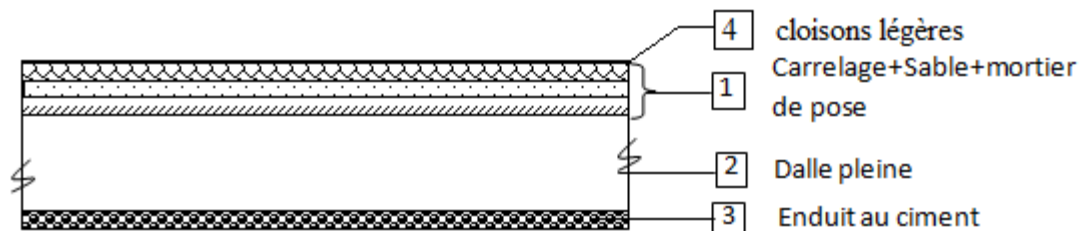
Coupe transversale d'un plancher à dalle pleine
